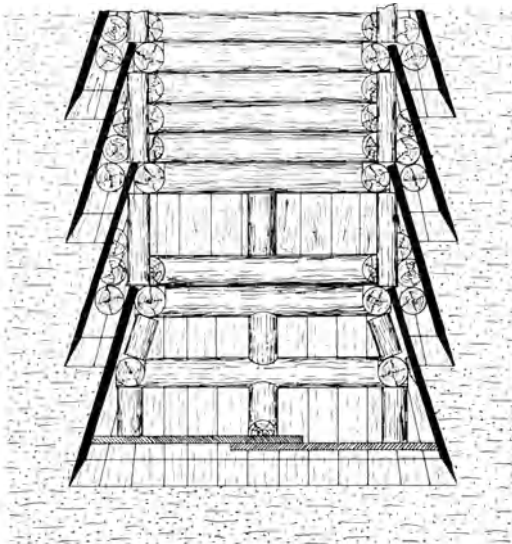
Ausbau eines Getriebefeldes mit Halbholzschrot.
